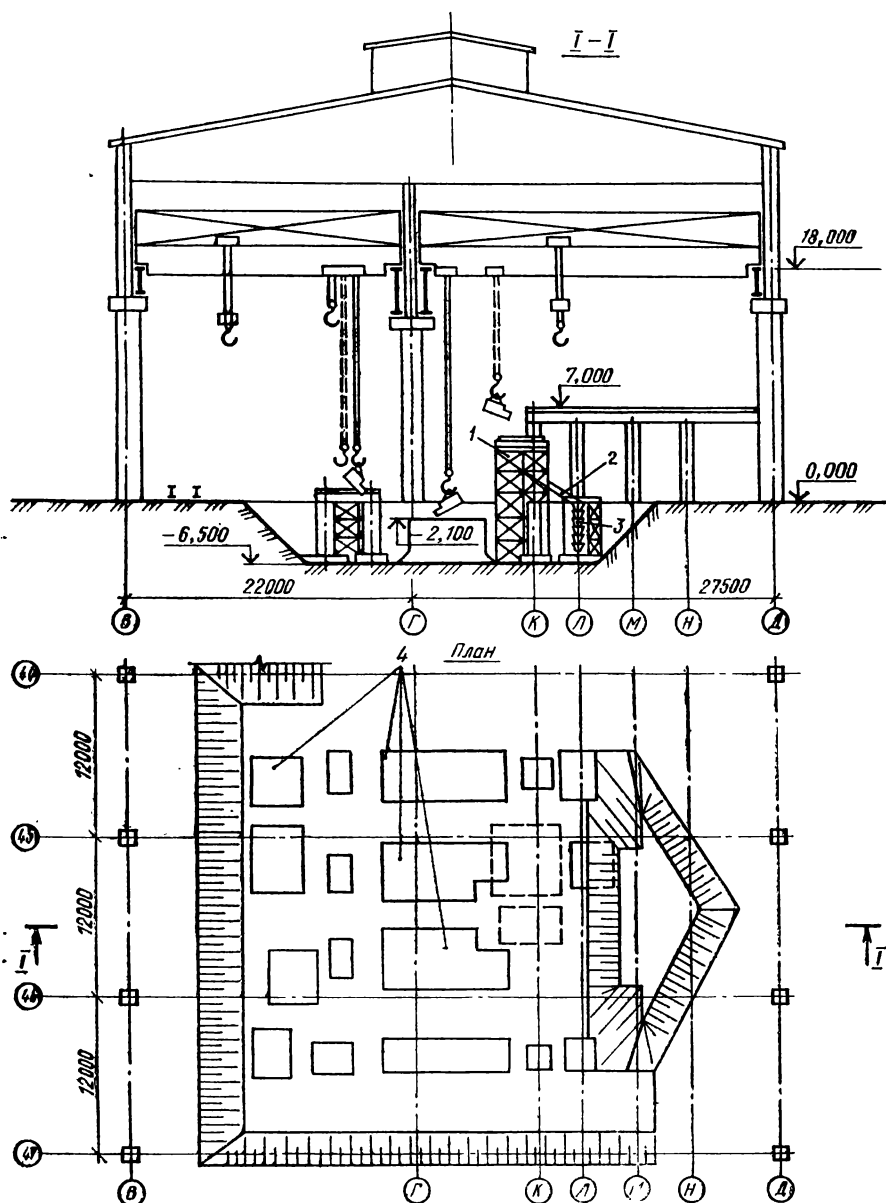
Схема бетонирования фундаментов при помощи мостового крана:
